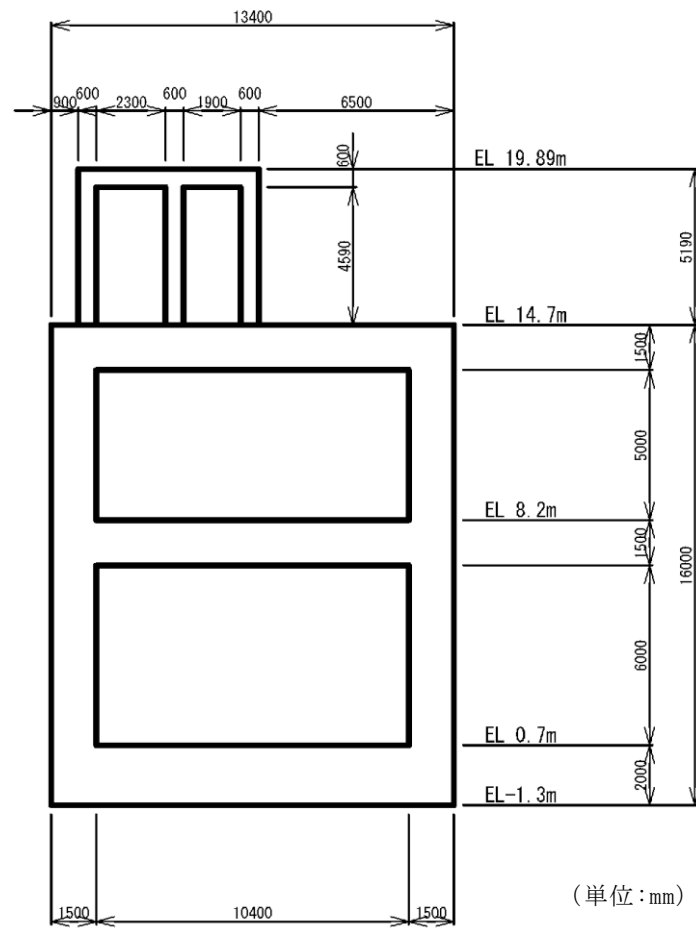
低圧原子炉代替注水ポンプ格納槽 断面図 (E-E断面)
